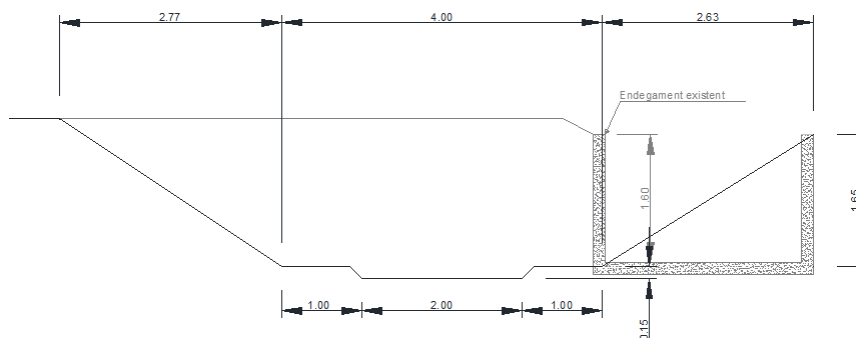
Secció de l'endegament en terres comparada amb la secció existent.
